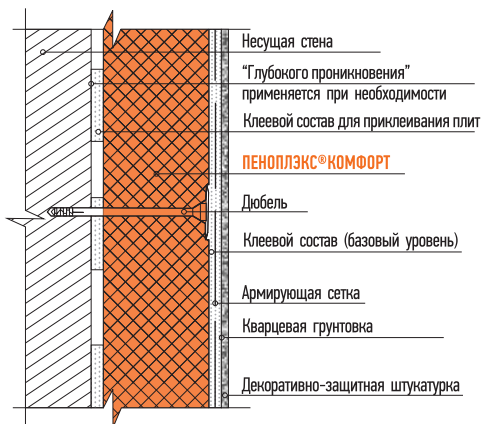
Теплоизоляция стены с отделкой штукатурной смесью
